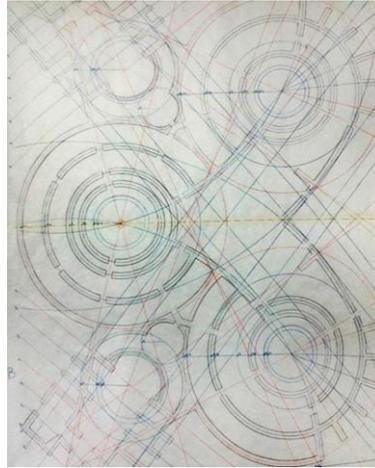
Trabajo de planta de trazado a escala de la propuesta elegida para ejecutarla 1:1. Fuente: Arentsen, E. (2018)
